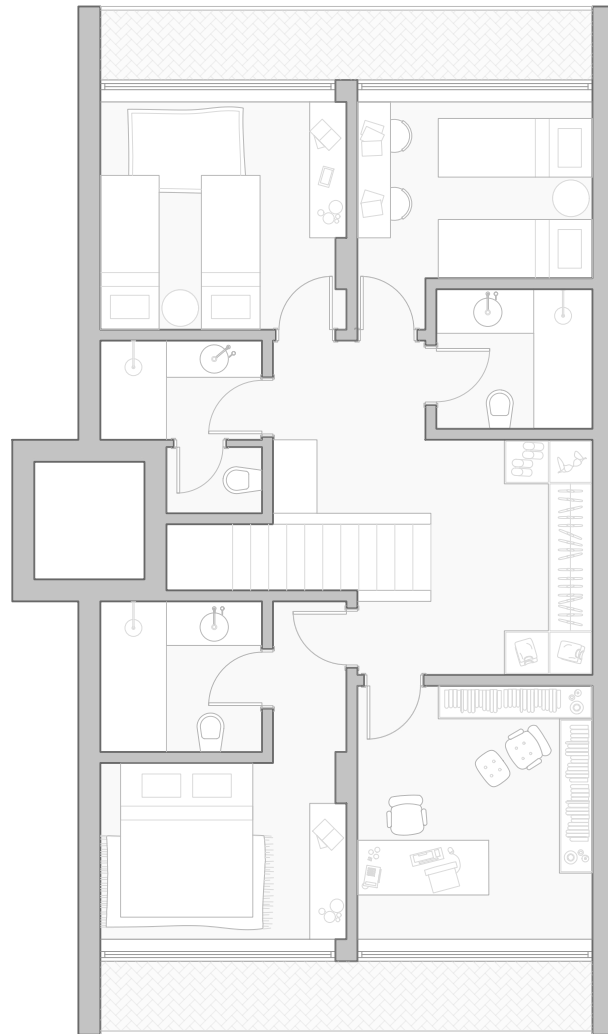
Planta T4 2x1 Piso Superior 1:100
